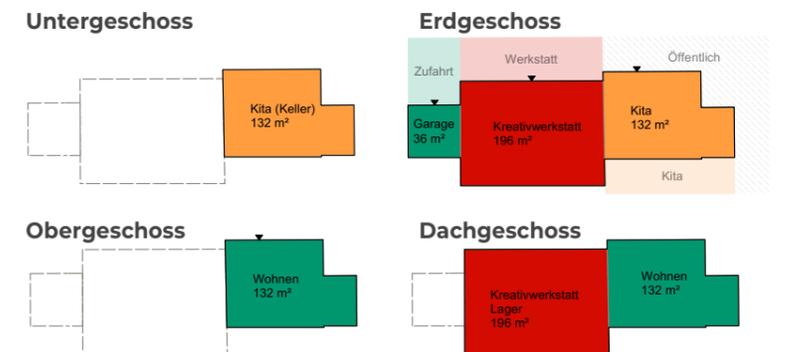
Eigene Darstellung schematischer Grundriss Werkhof
